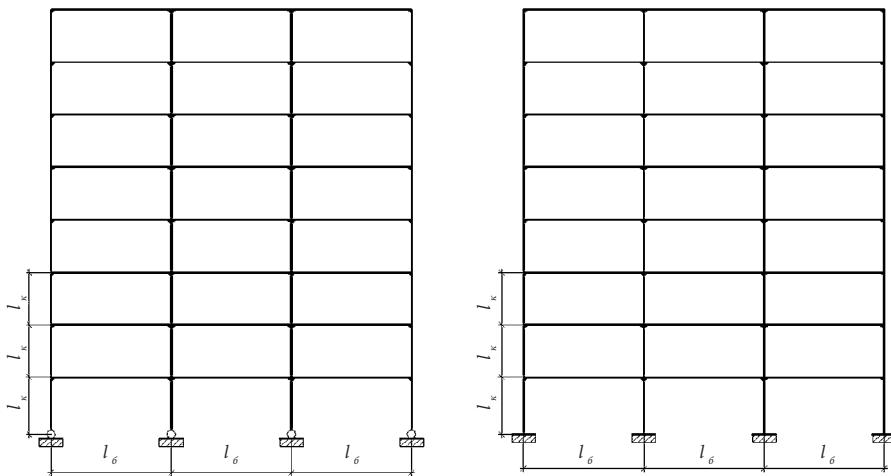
Рамные каркасы: а) шарнирное крепление колонн к фундаменту; б) жесткое крепление колонн к фундаменту
